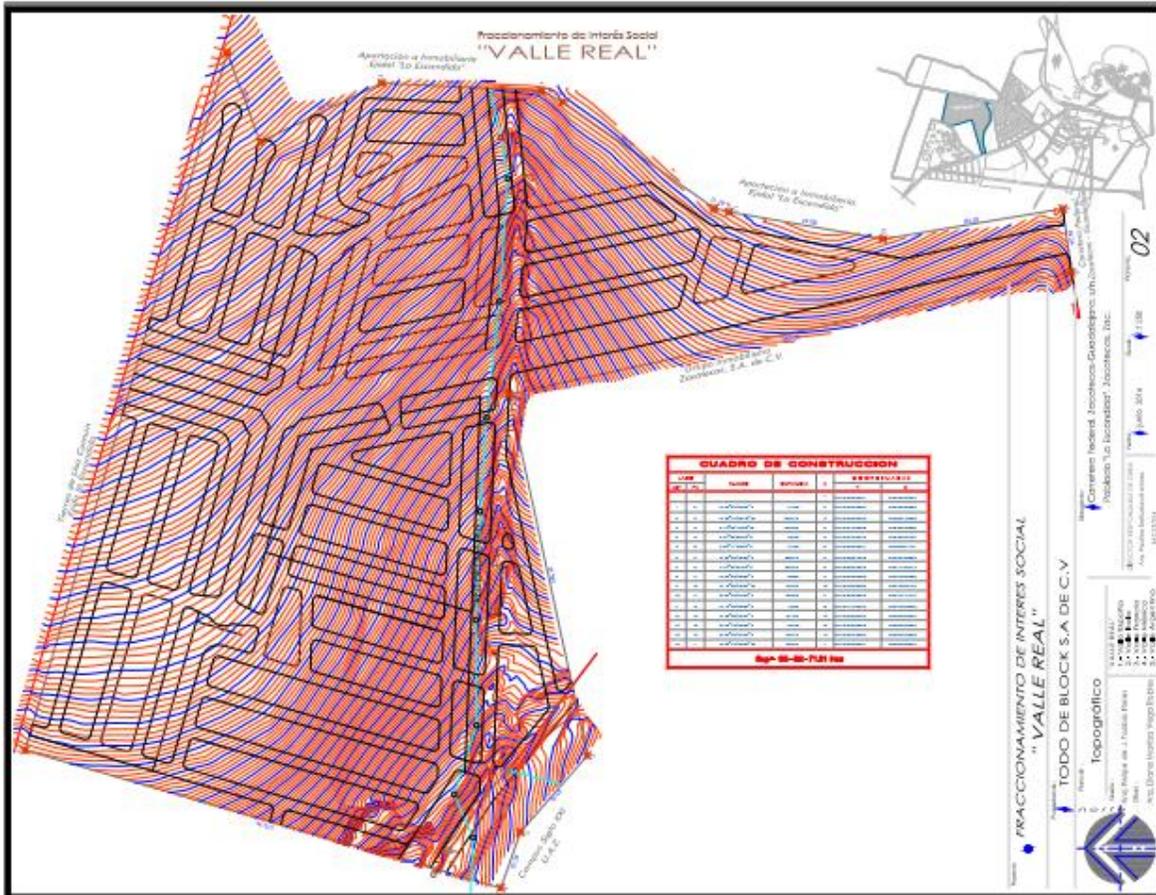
Plano topográfico proyecto Fraccionamiento Valle Real.
